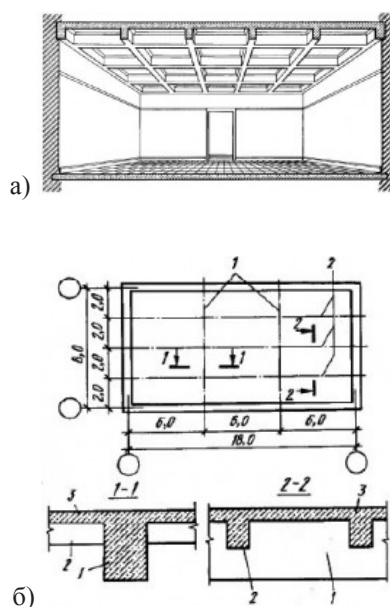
Монолитные железобетонные перекрытия: а) кессонное; б) ребристое
